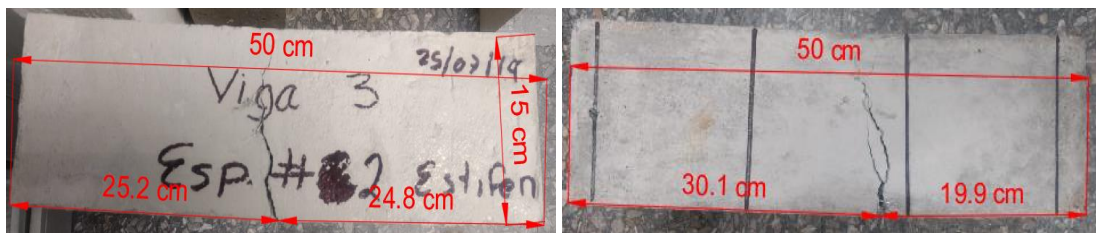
Modos de falla de las vigas ($Vf - 3$) y ($Vf - 4$) del espécimen 2 con FA ($Ef - 2$).
